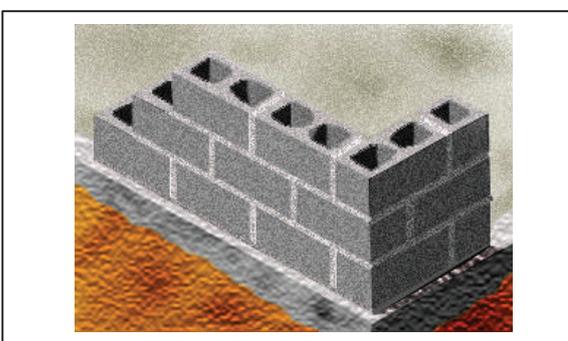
Amarração de Painéis com Blocos – 1ª Fiada
